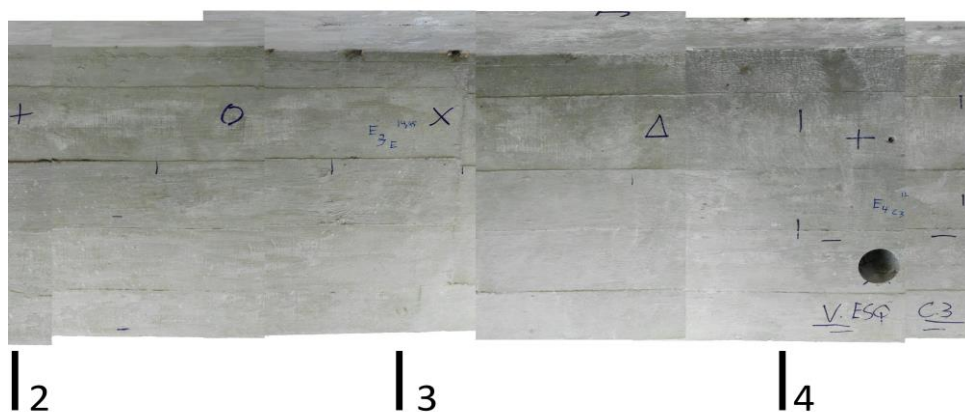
Foto da viga esquerda entre os 2 e 4,5 metros
